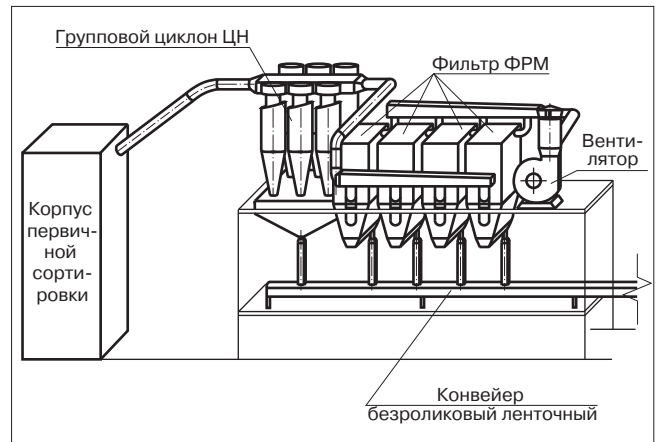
Схема установки пылеулавливания корпуса первичной сортировки
